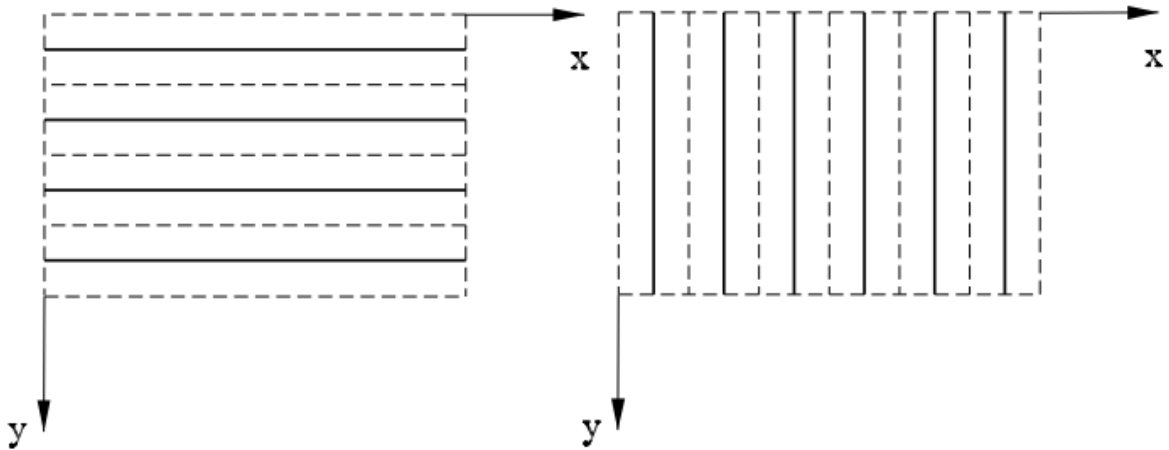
Divisão de uma laje em faixas e respectivos elementos barra [5]
